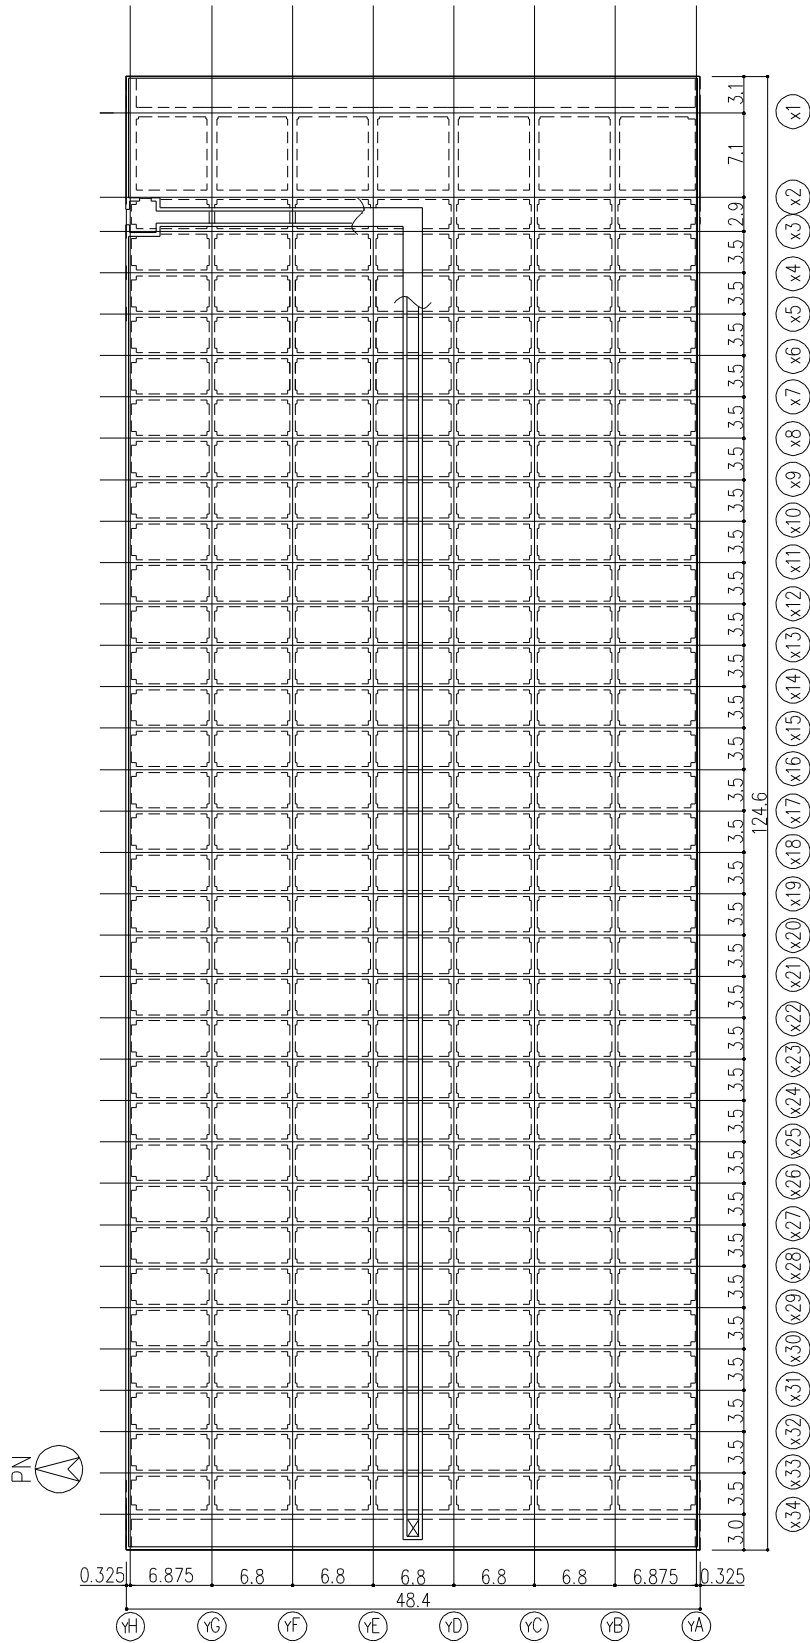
屋上階平面図 (G.L. +9.1) (单位 : m)
